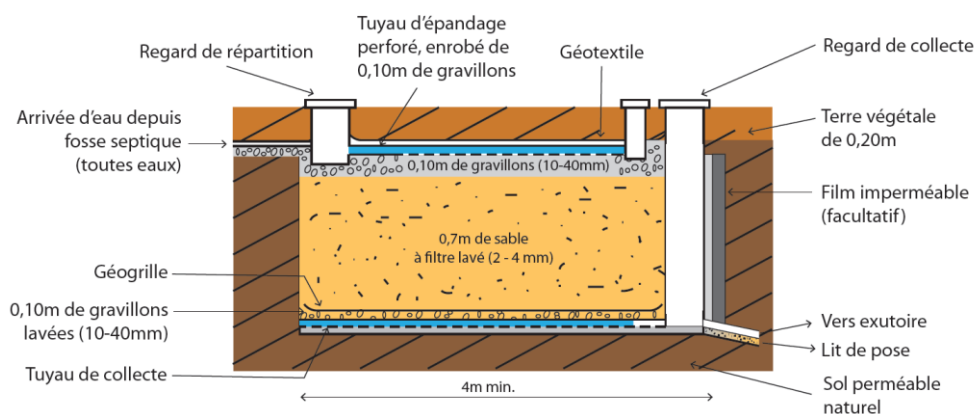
Coupe longitudinale d'un filtre à sable vertical drainé
